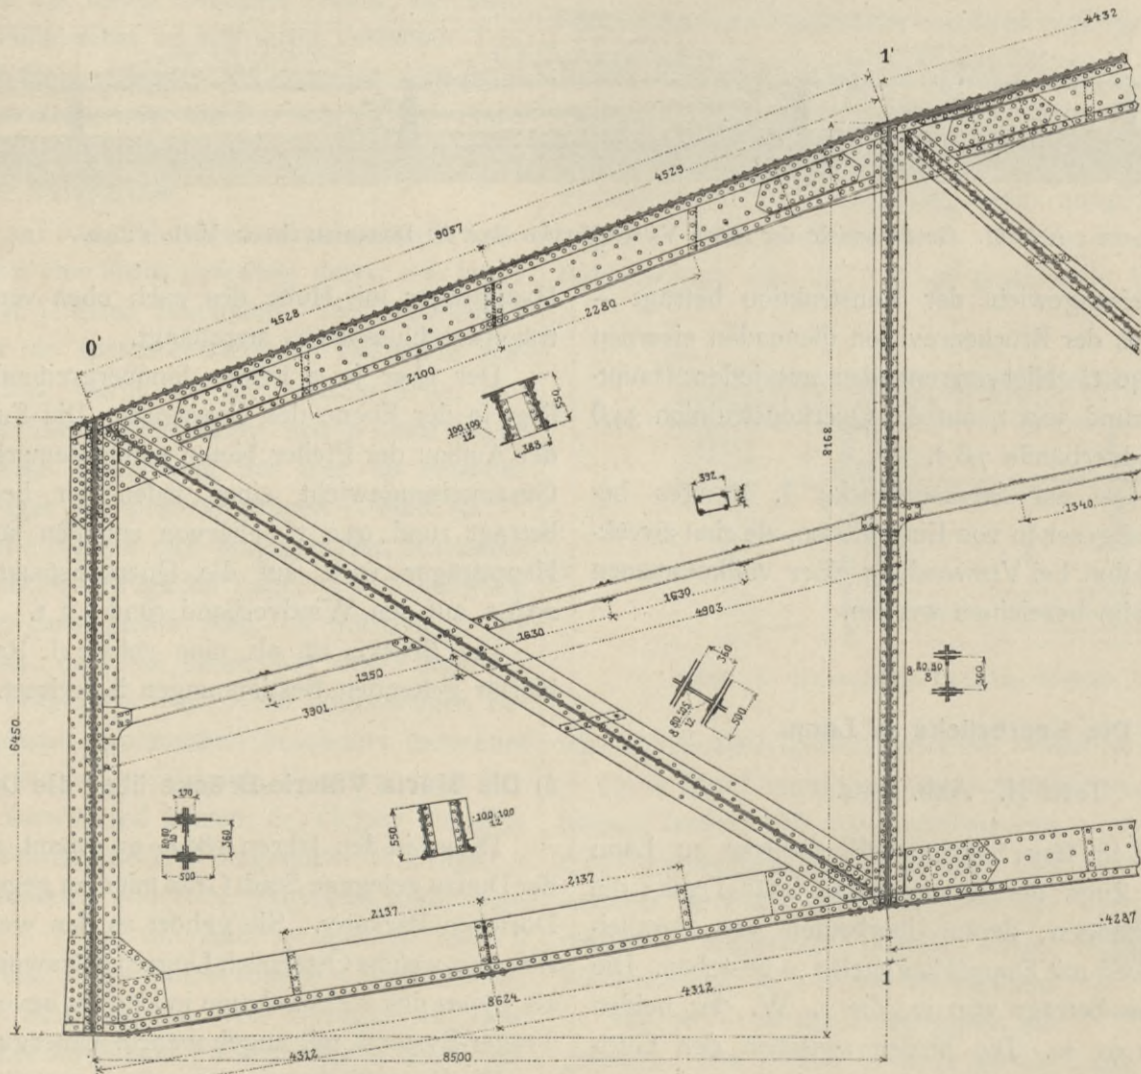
Die Ausbildung des Hauptträgers (St. W. 102,0 m). 1 : 80.
